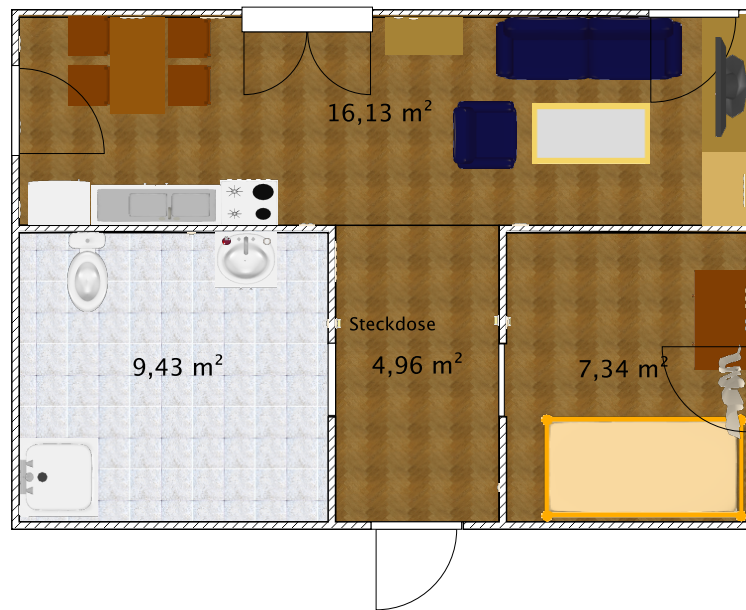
AGT Labor Grundriss (Quelle: Eigene Darstellung)
